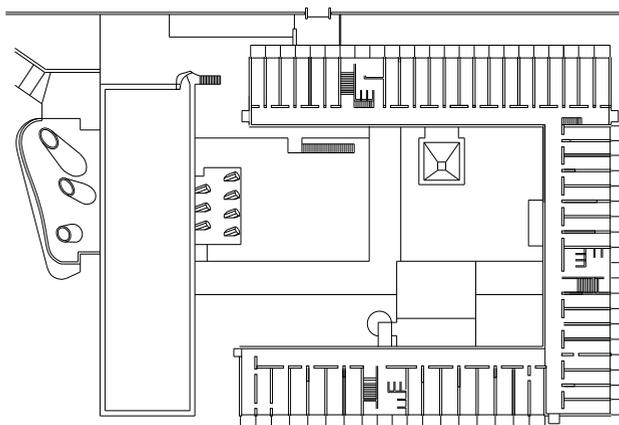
Plan d'un étage privatif de Sainte-Marie-de-la-Tourette
